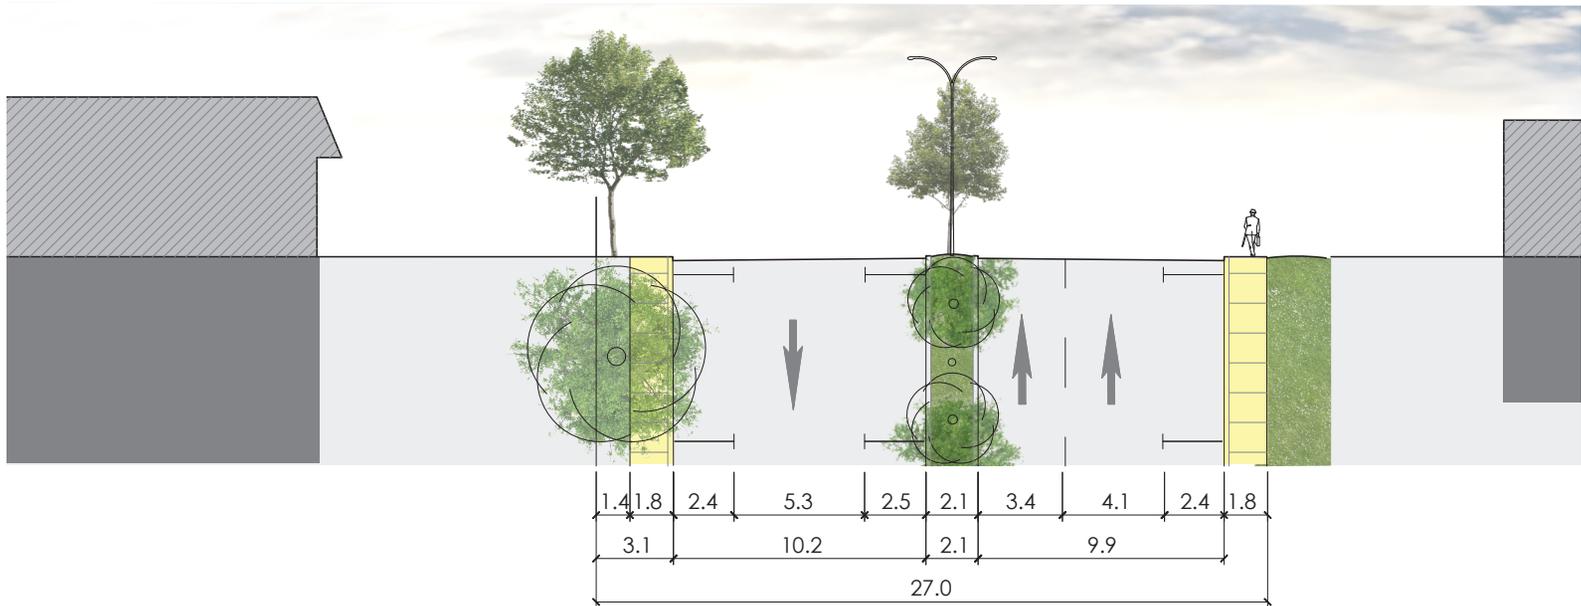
Coupe A2-A2', Existant - boulevard St-Laurent entre Rue Jean-Talon et Rue de Castelnau O, échelle 1:300
